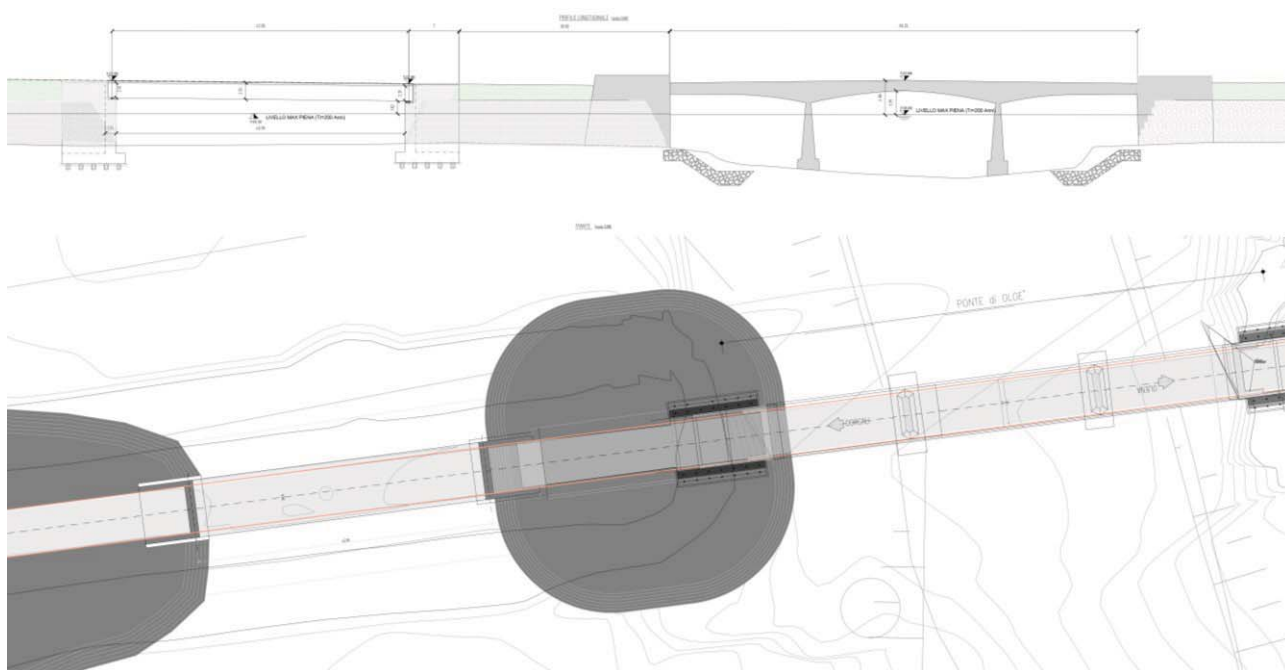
Prospetto e Planimetria del nuovo viadotto
